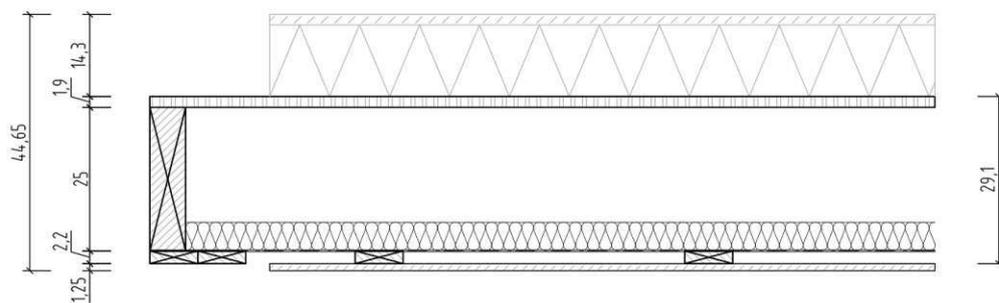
Geschoßdecke Haus F (Quelle: eigene Darstellung)
